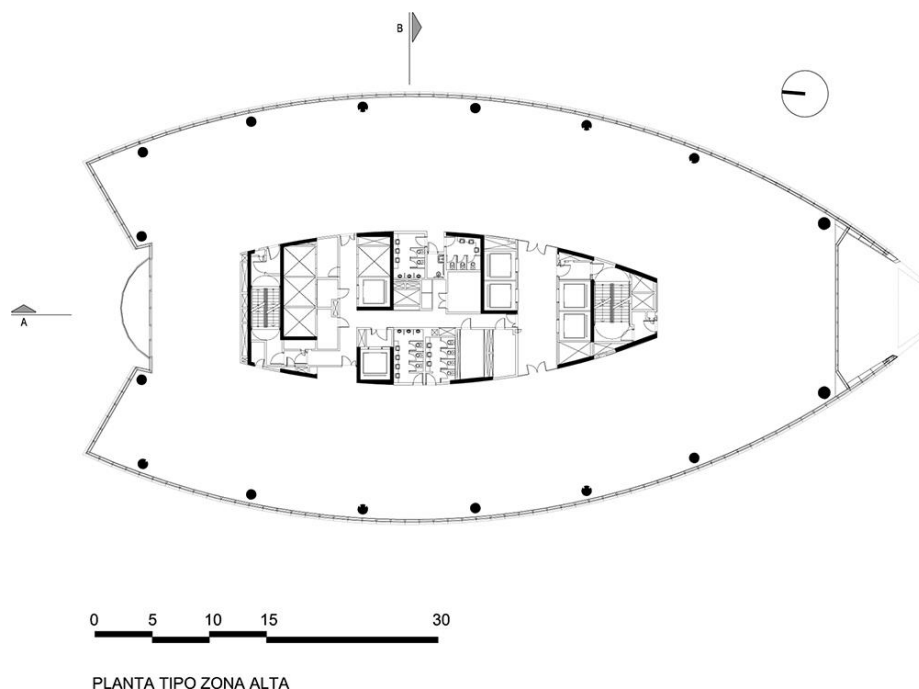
Infinity Tower – Planta Pavimento Tipo (sem escala)
